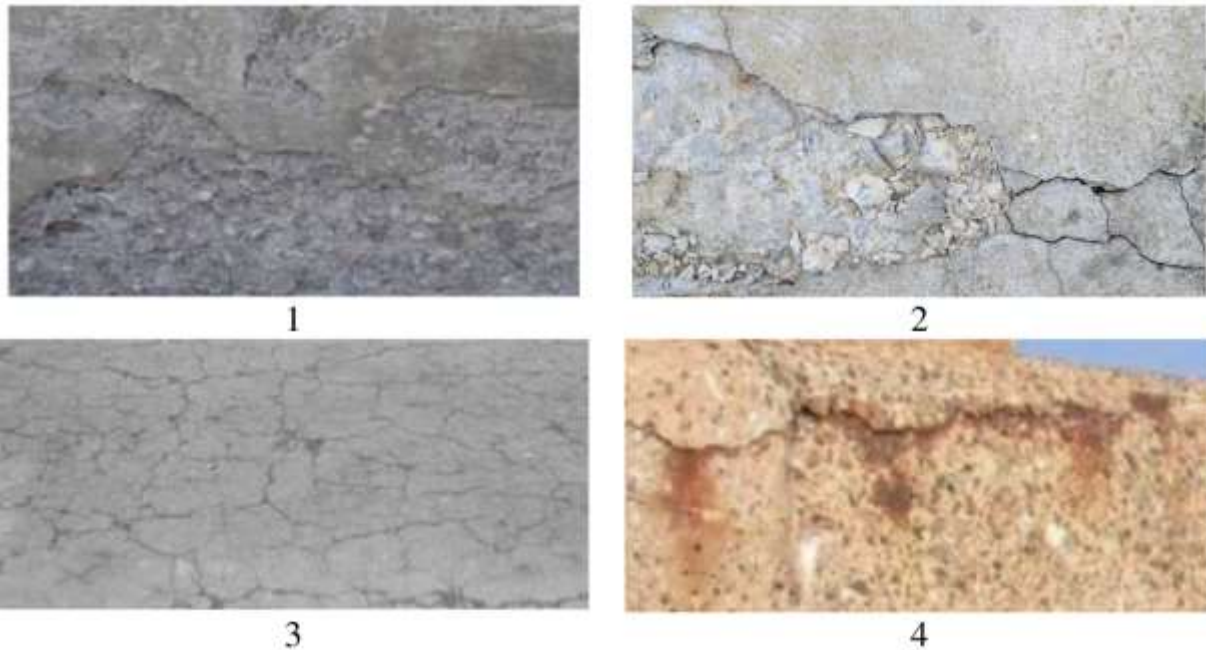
Поверхні пошкодження залізобетонних та бетонних конструкцій:
